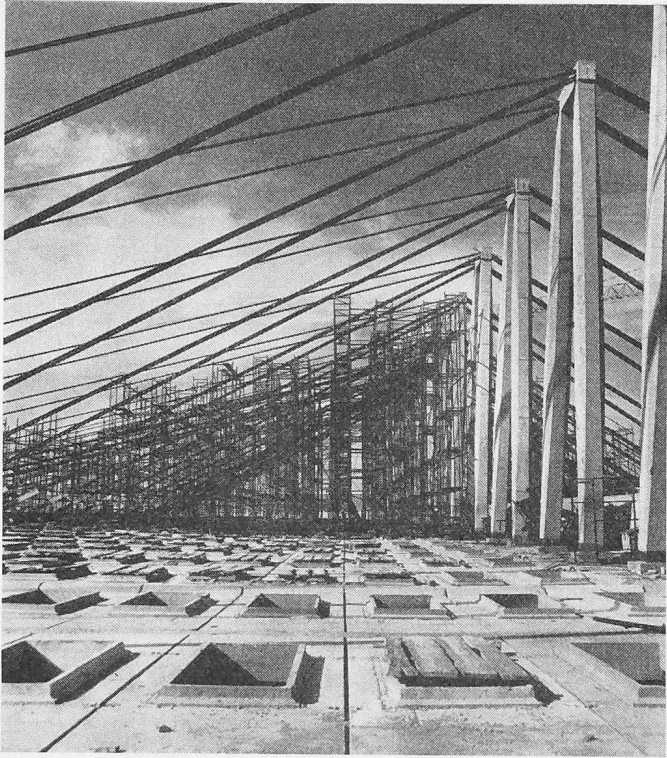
Die Dachplatte besteht aus vorfabrizierten Elementen von 1,55 m Breite und 4,98 m Länge
